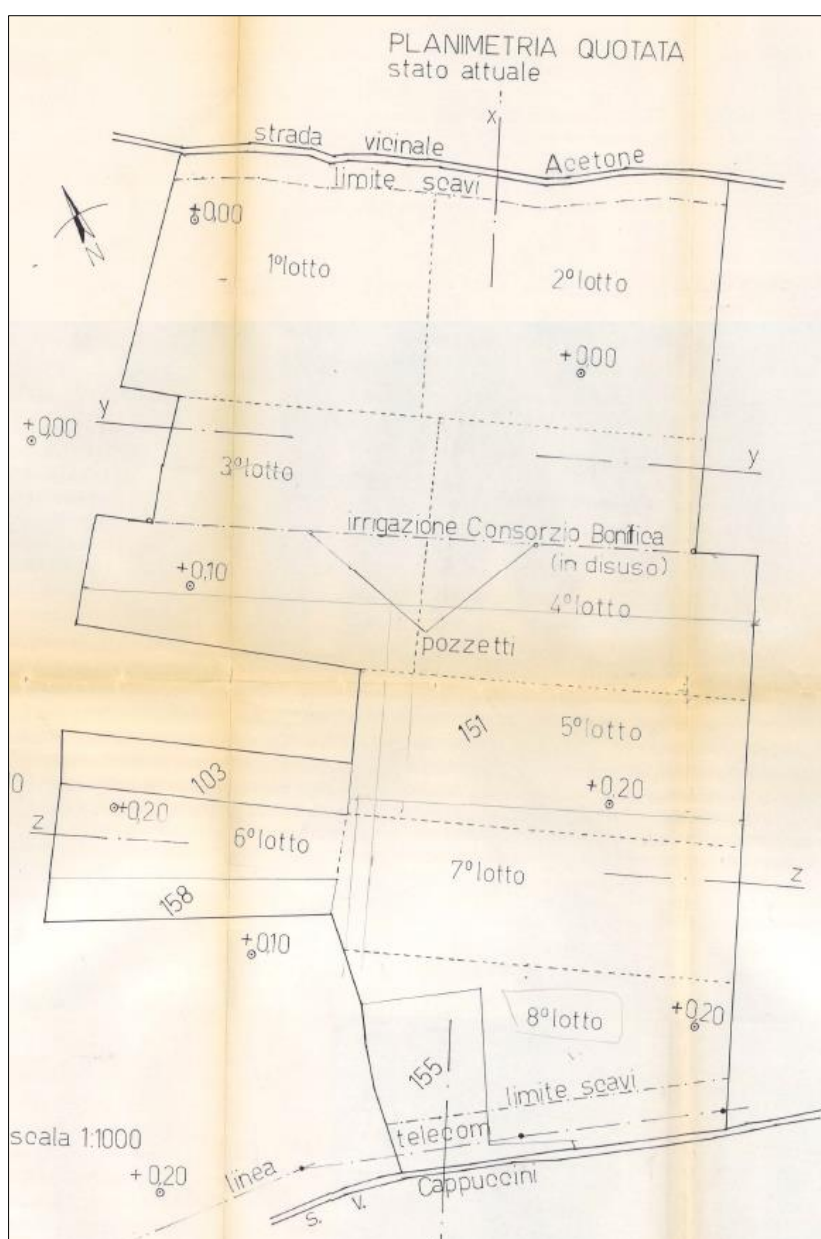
planimetria di coltivazione della cava con la suddivisione dei lotti allegata al primo provvedimento autorizzativo
